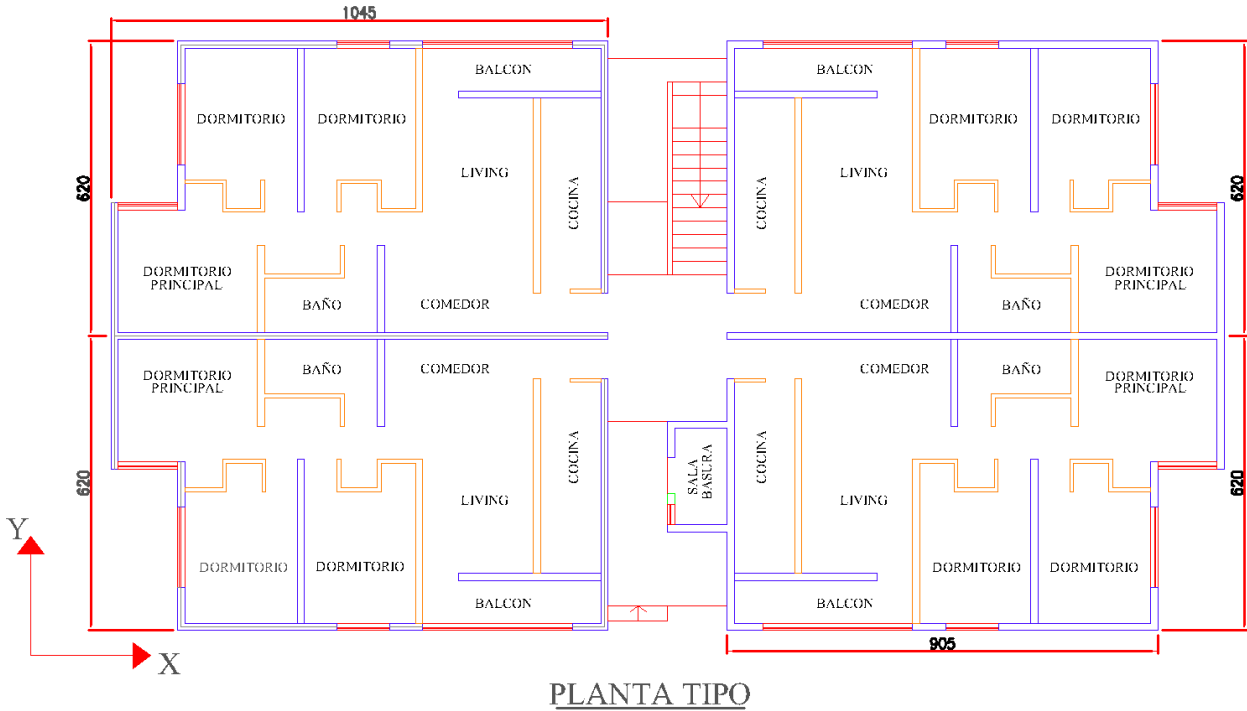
Distribución en planta estructura (medidas en centímetros).
